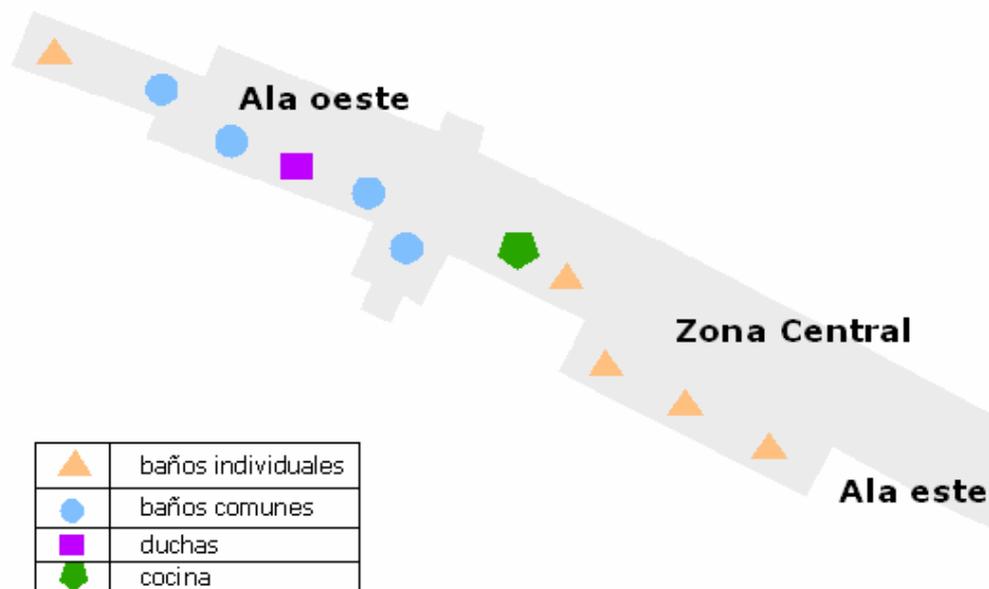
Ubicación de los locales húmedos en ala oeste y zona central
